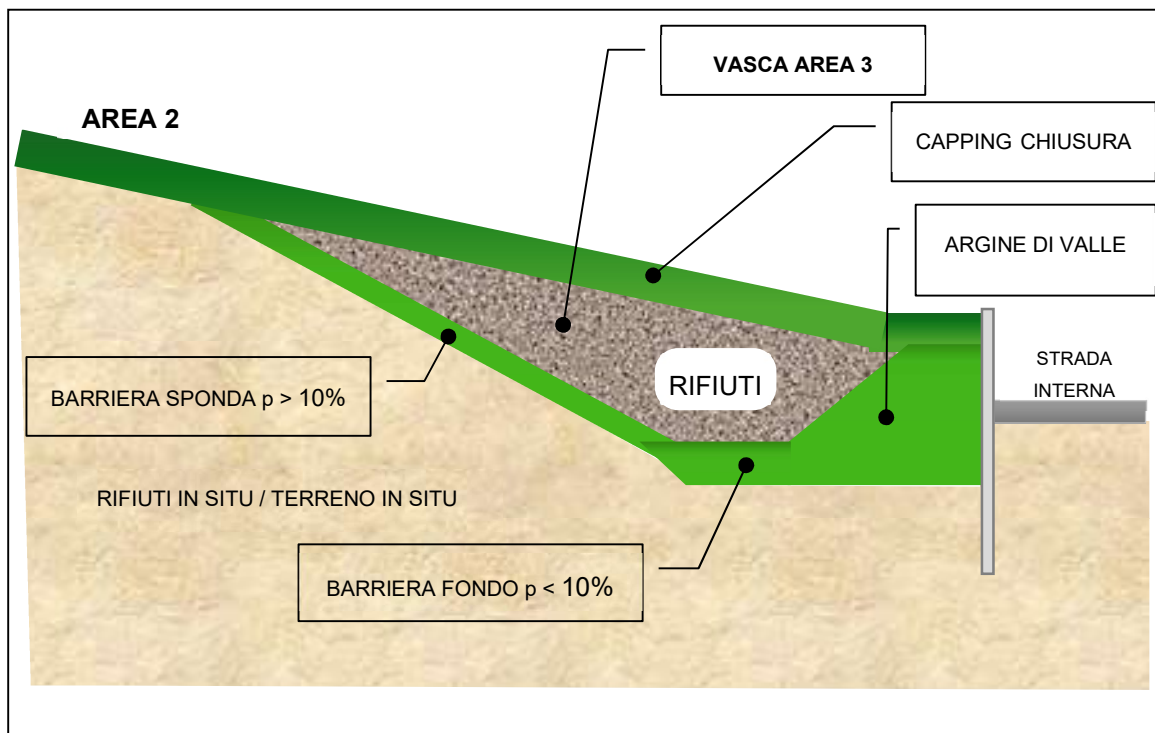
SEZIONE SCHEMATICA AREA 3
